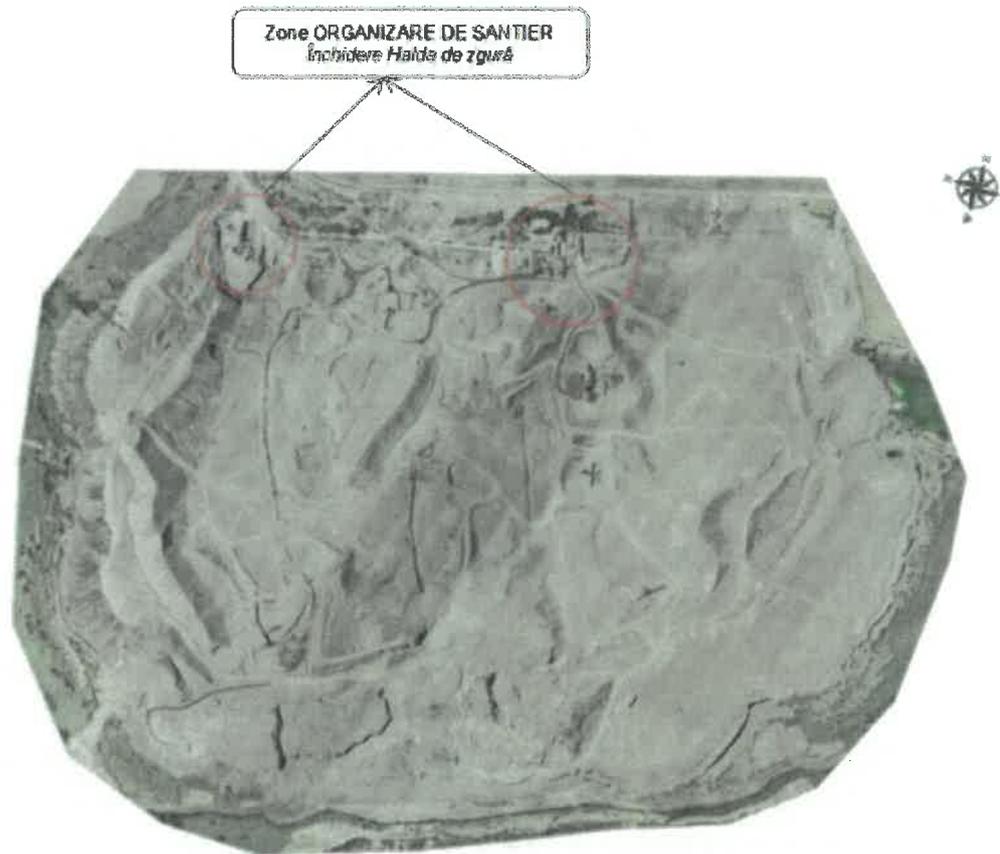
Poziționare organizare de șantier pentru proiectul de închidere haldă
